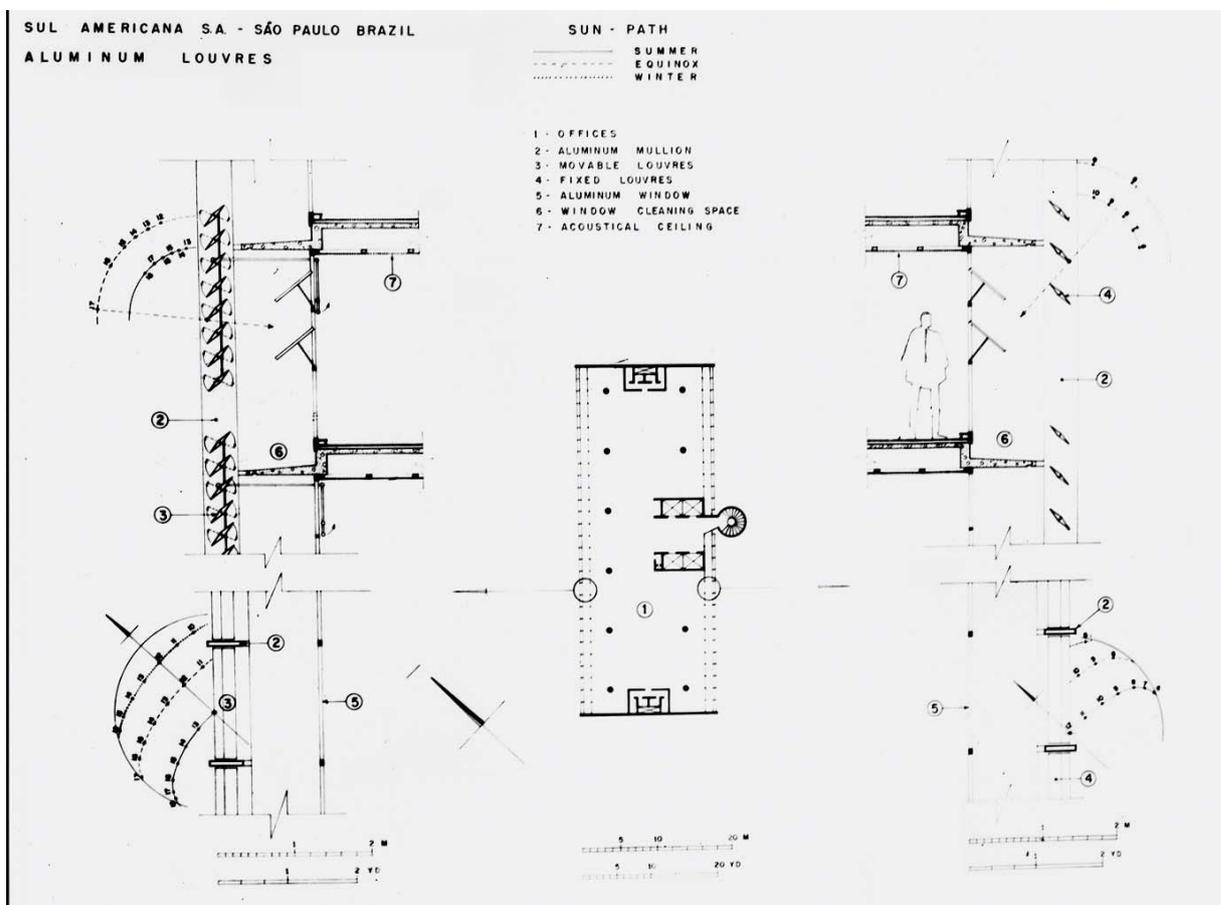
Detalhe do sistema de fachadas e planta pavimento-tipo do edifício em 1963. Acervo digital Rino Levi – FAU PUC Campinas
